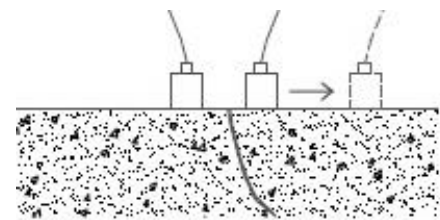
Lectura de la orientación de fisuras/grietas en el hormigón
